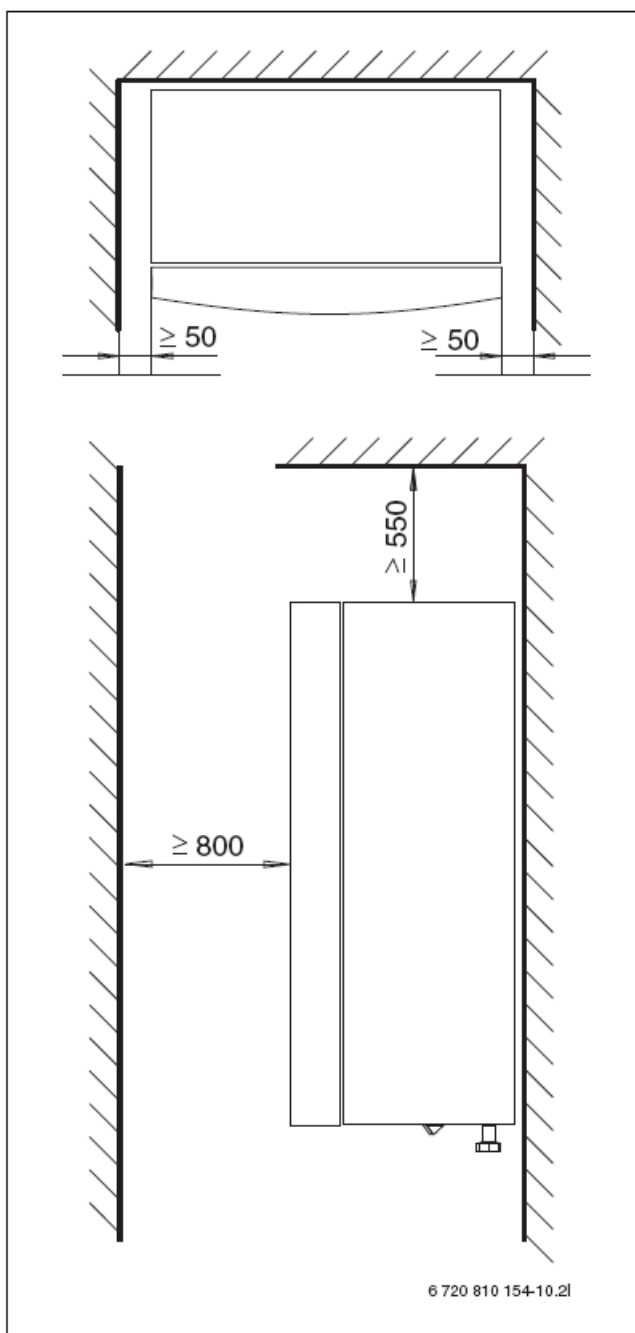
Минимальные отступы от стен для теплонасосного блока при монтаже на стене
